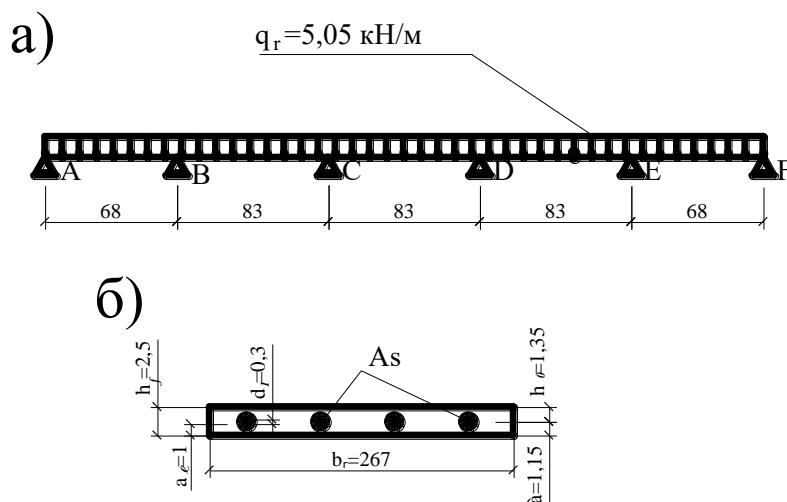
Розрахункова схема та розрахунковий переріз плити
